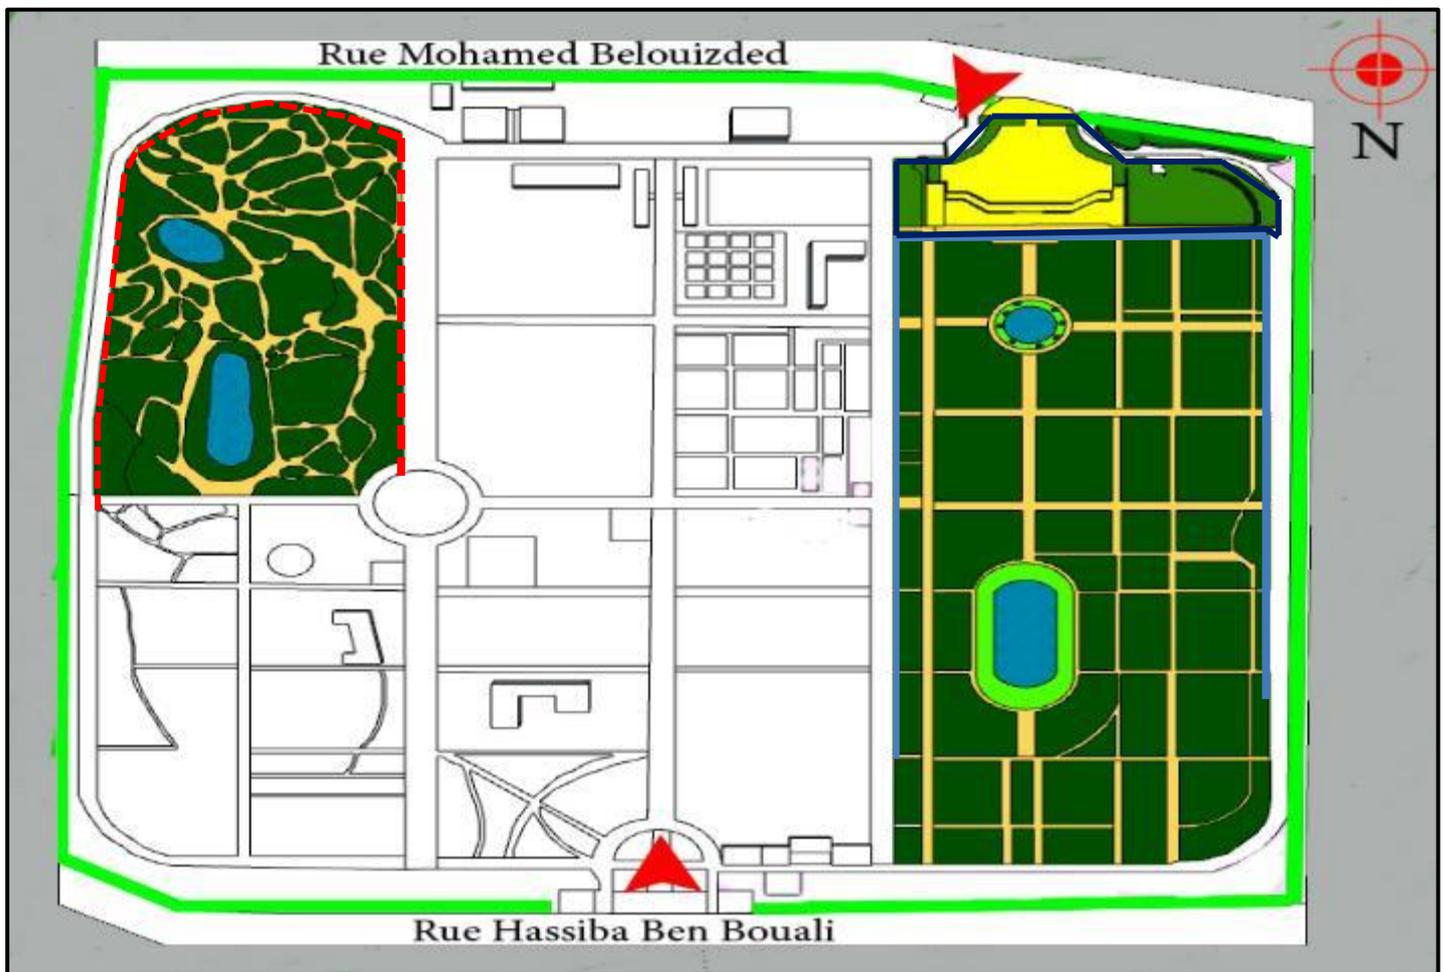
plan de masse du jardin d'essai traité par l'auteur
